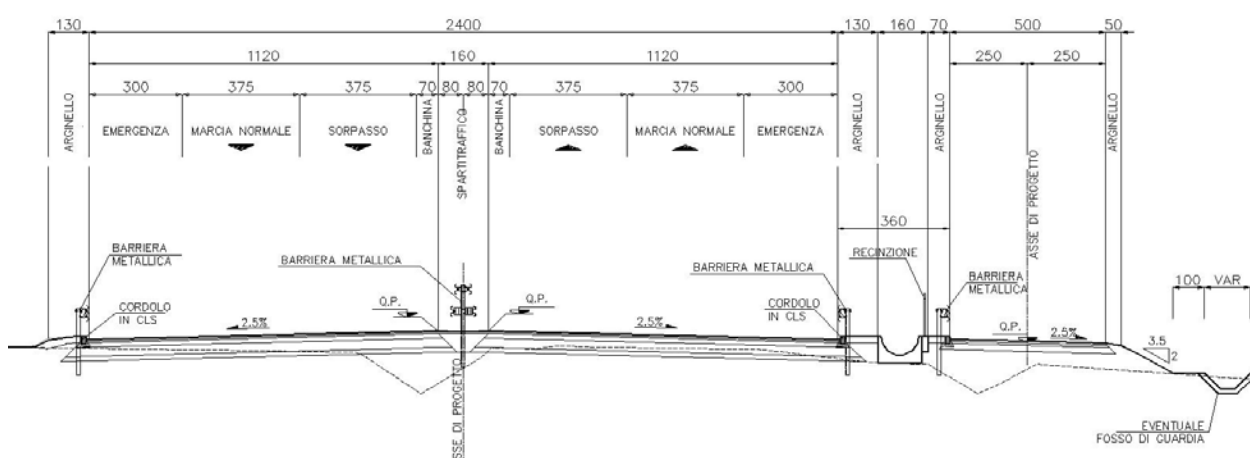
Sezione tipo di progetto con viabilità secondaria in complanare (adeguamento SS1 Aurelia)
